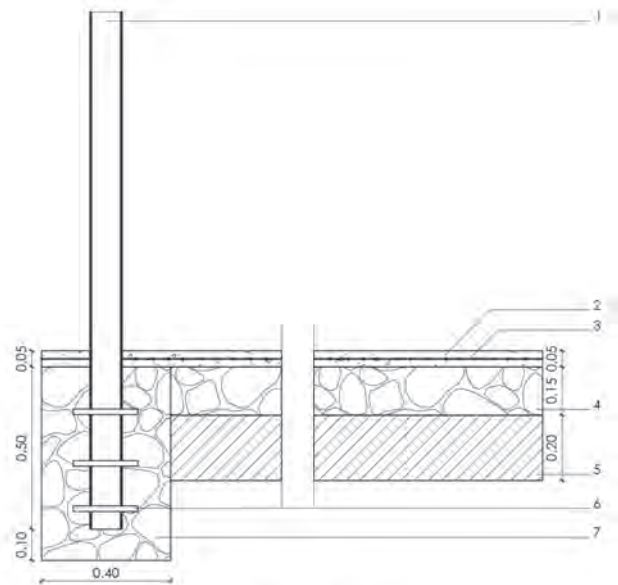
Detalle de cancha multiuso y cerramiento
